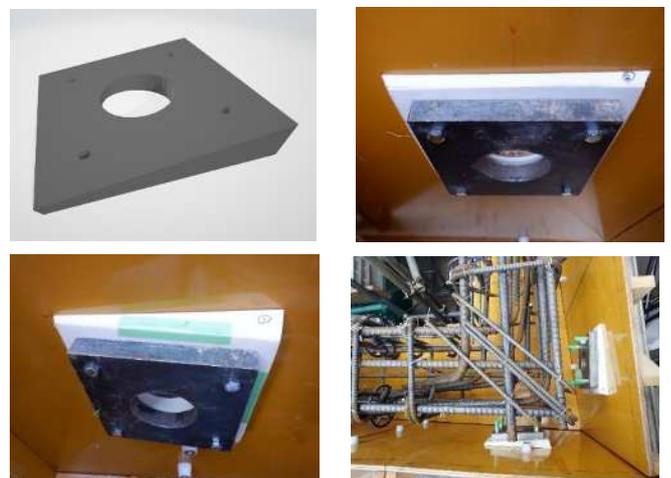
ヌスミ型枠 3D モデルおよび施工状況
